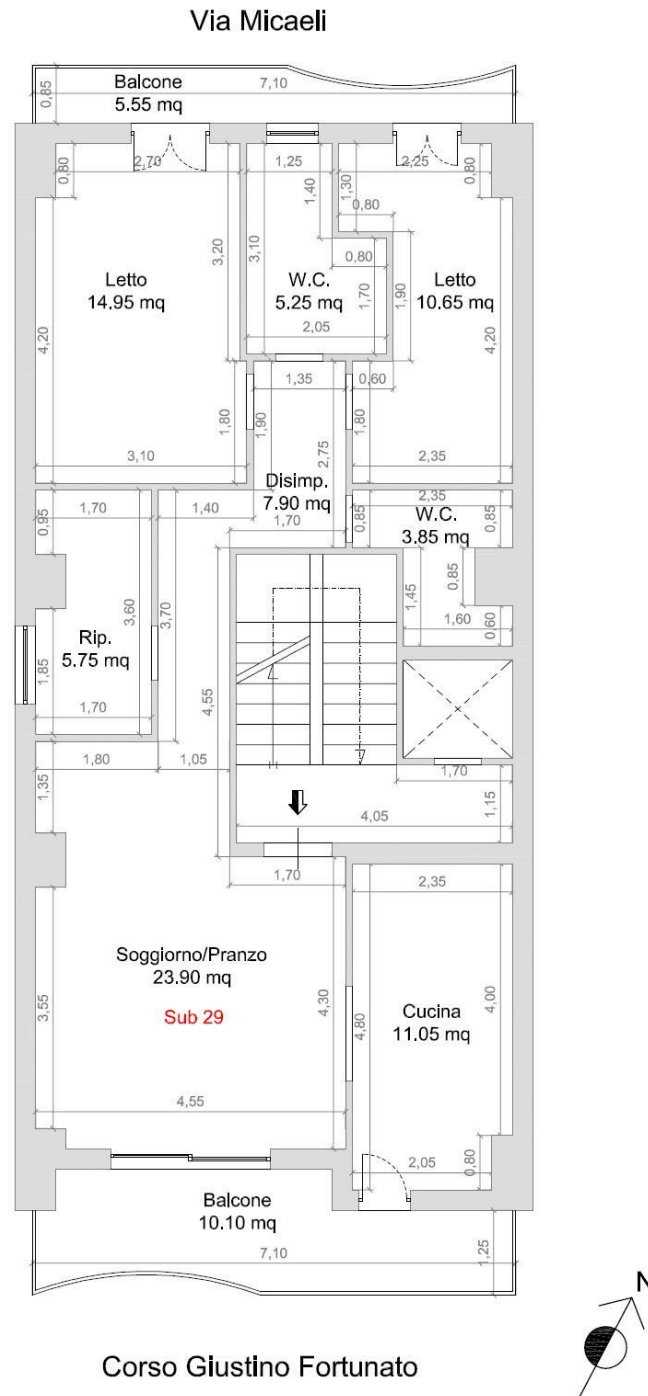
Planimetria Stato di Fatto Appartamento Piano Quarto
